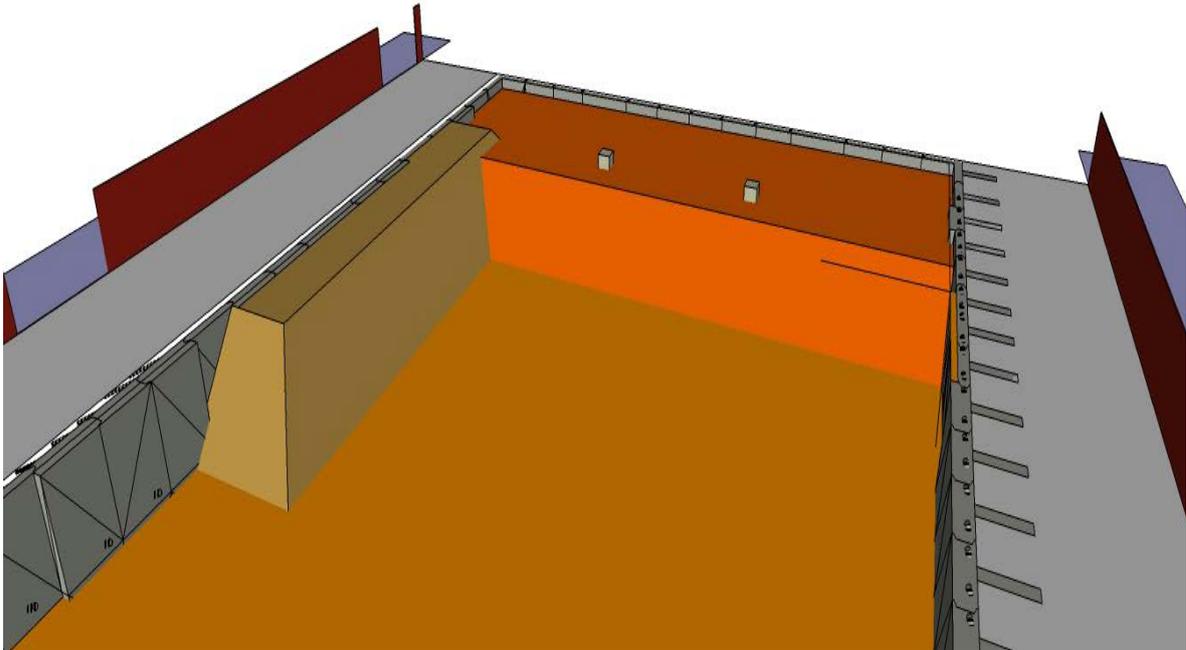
Baugrubenaushub vor dem Abtragen der Erdschicht [5]
